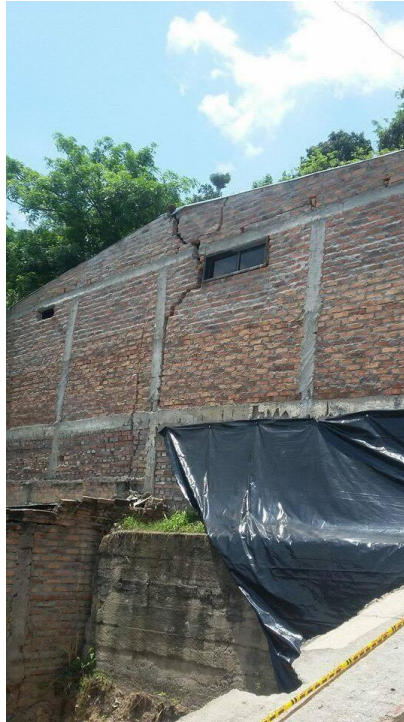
, Desplome de vía y deterioro de vivienda por construcción inadecuada
